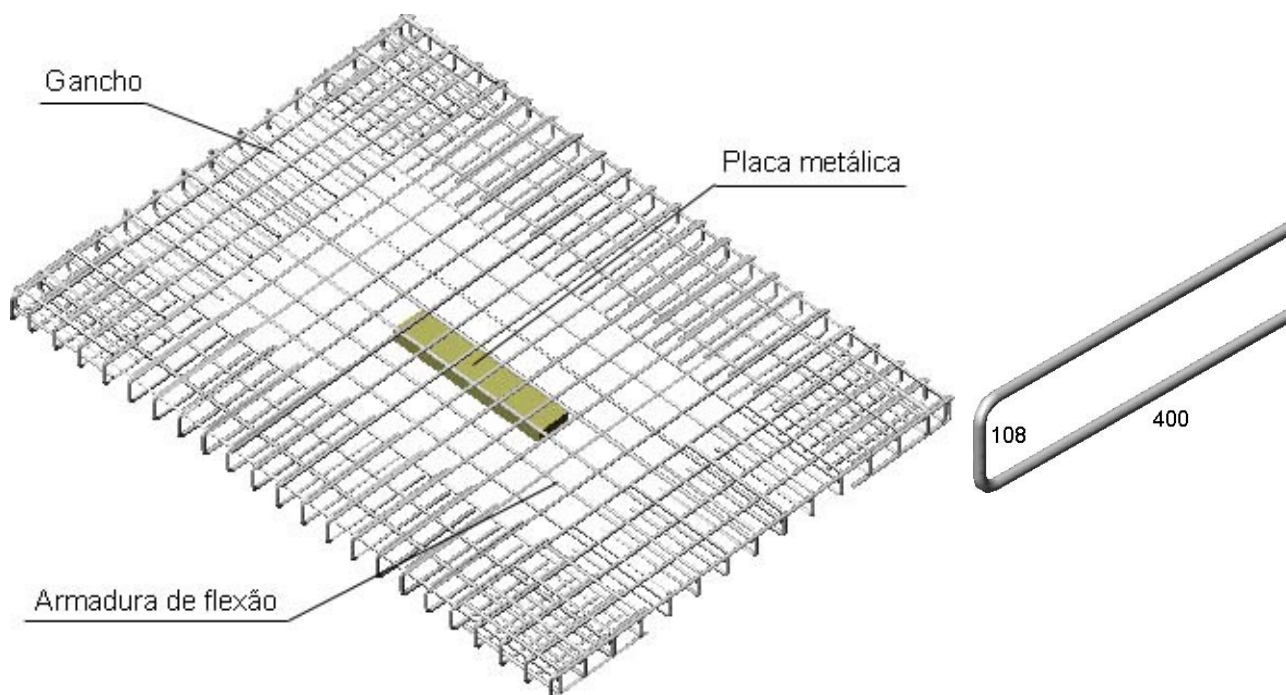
Armadura principal e grampos das lajes (Oliveira, 2003)
